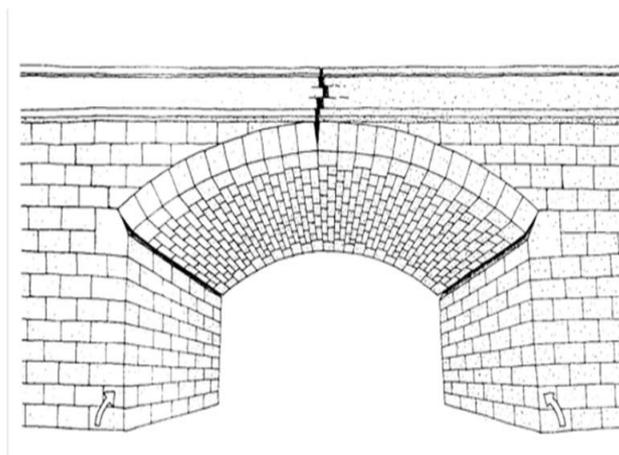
FIS-12 Descripción: Fisuración transversal del intradós en los arranques y del trasdós en la clave.
